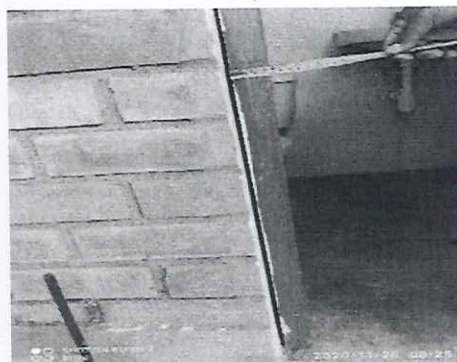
Vista de luz existente entre marco de puerta y muro de albañilería.
